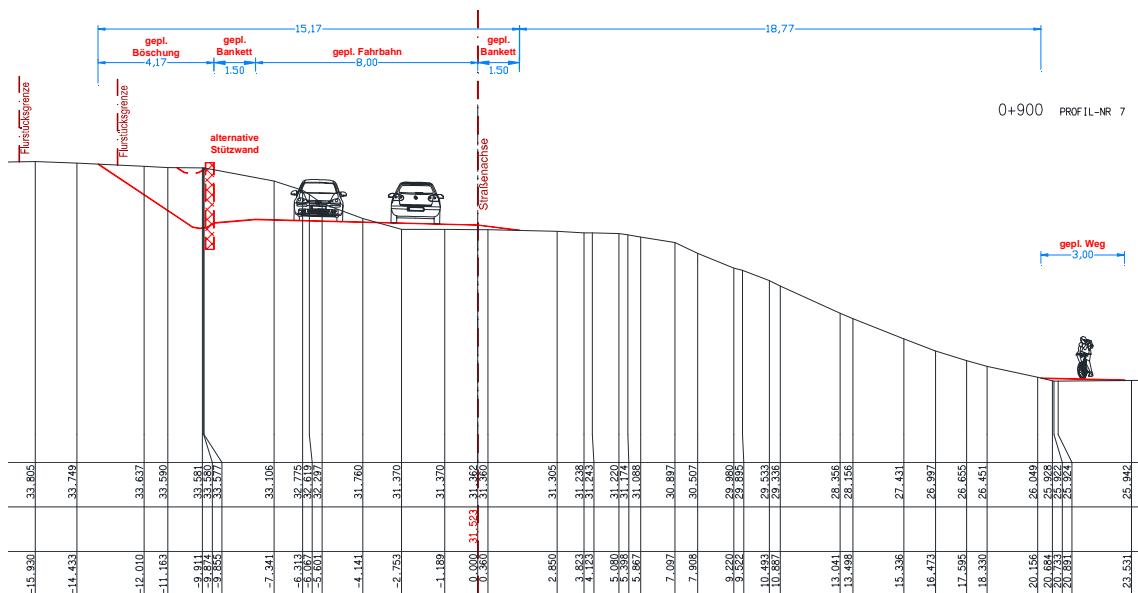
Abschnitt 2, Vorzugsvariante Trasse T1
